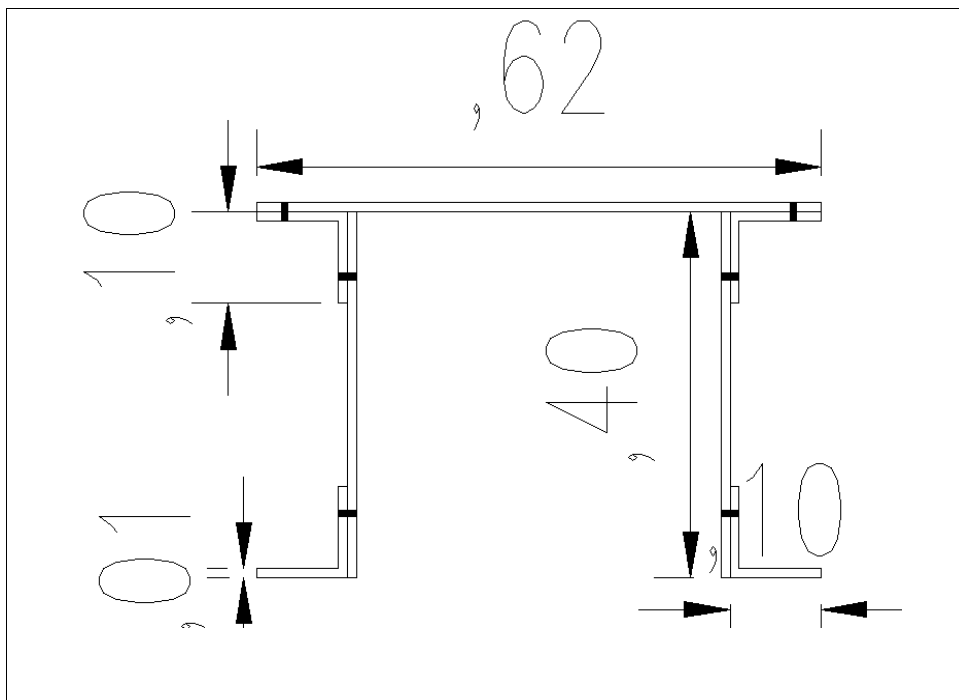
Sección del elemento tipo 3-4 (cordón superior), Puente 2. Fuente (Autores).
